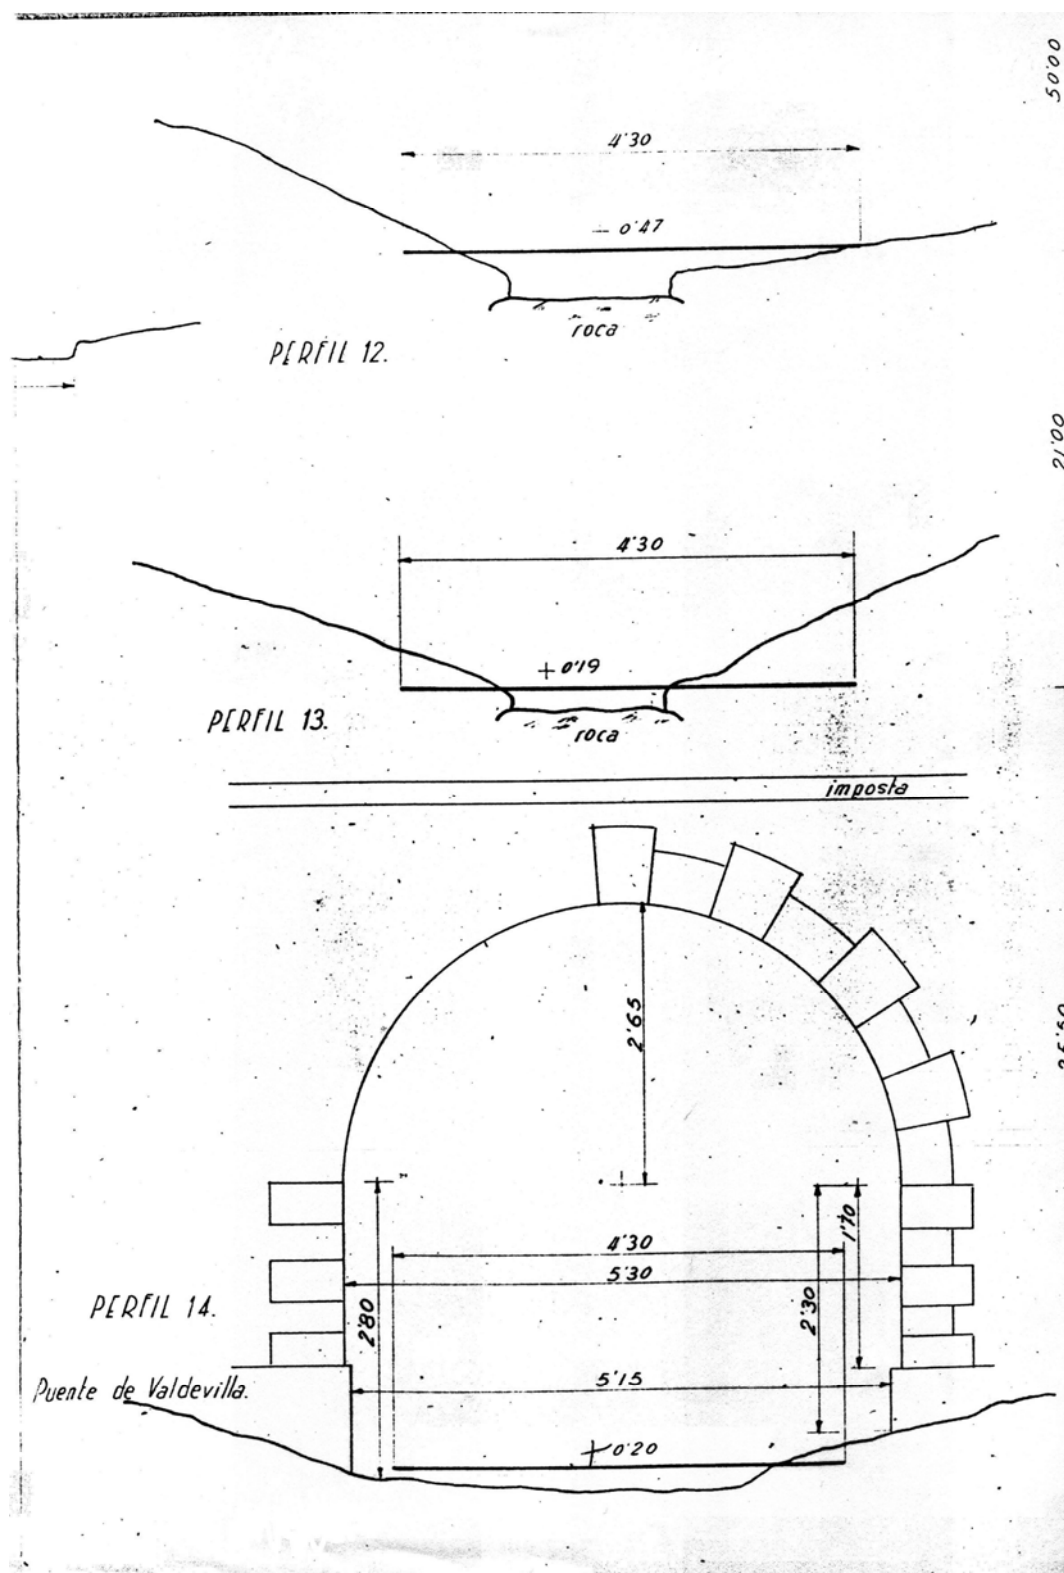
Geometría original del puente de Valdevilla antes de ser cubierto parcialmente, durante las obras de canalización y cubrición entre el citado puente y la carretera de San Rafael (año 1948).
